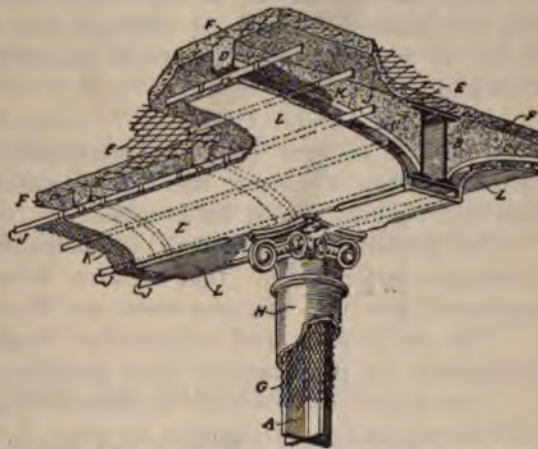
Fußboden, Decke und Säulenumhüllung aus Beton mit Streckmetalleinlage.
